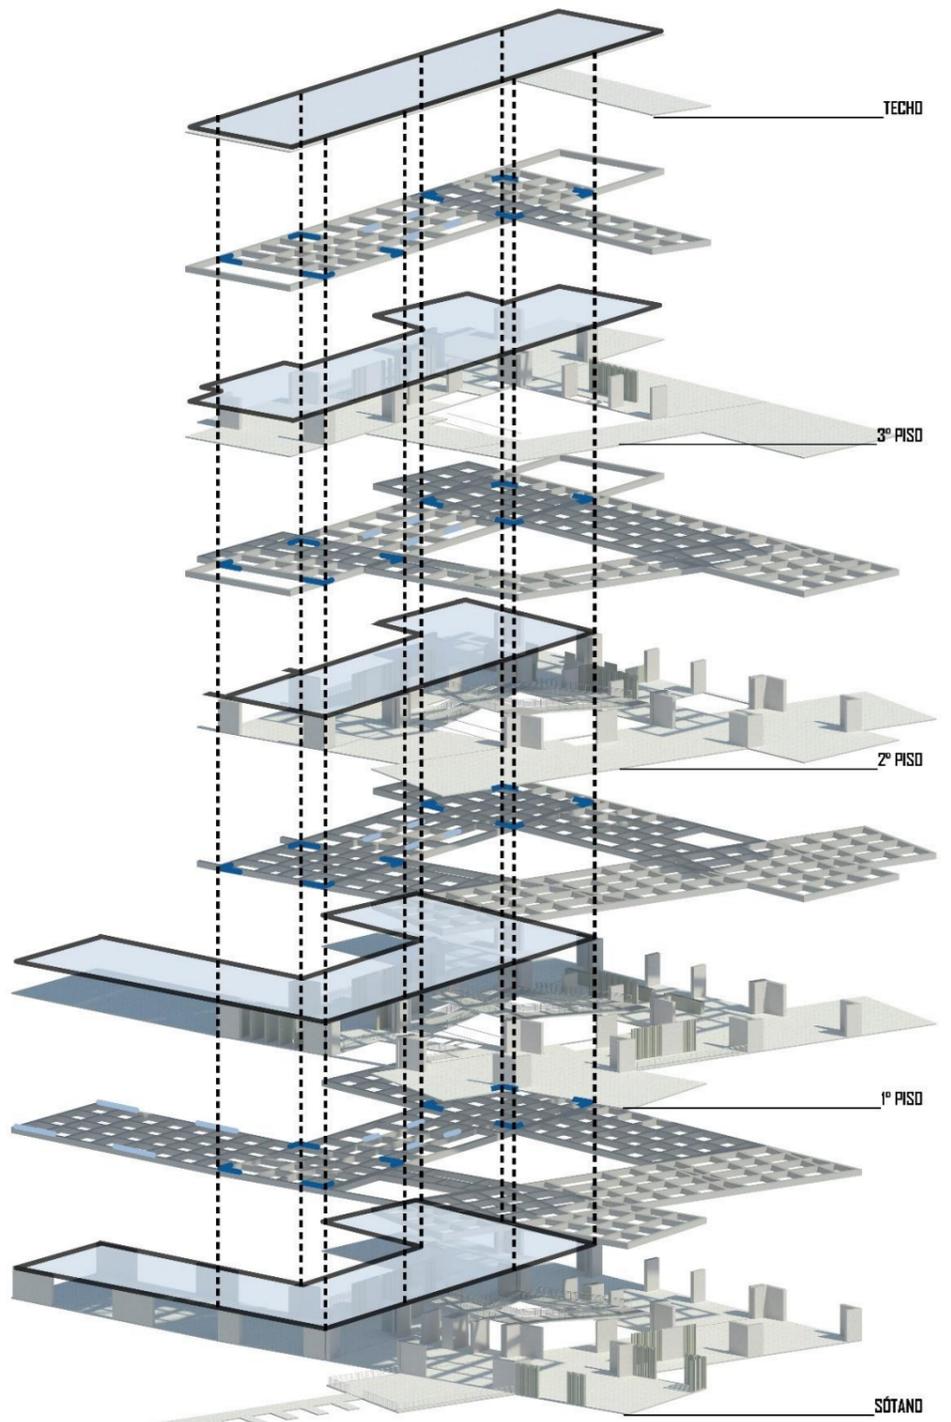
Estructura del módulo 1 con columnas tipo I y L
